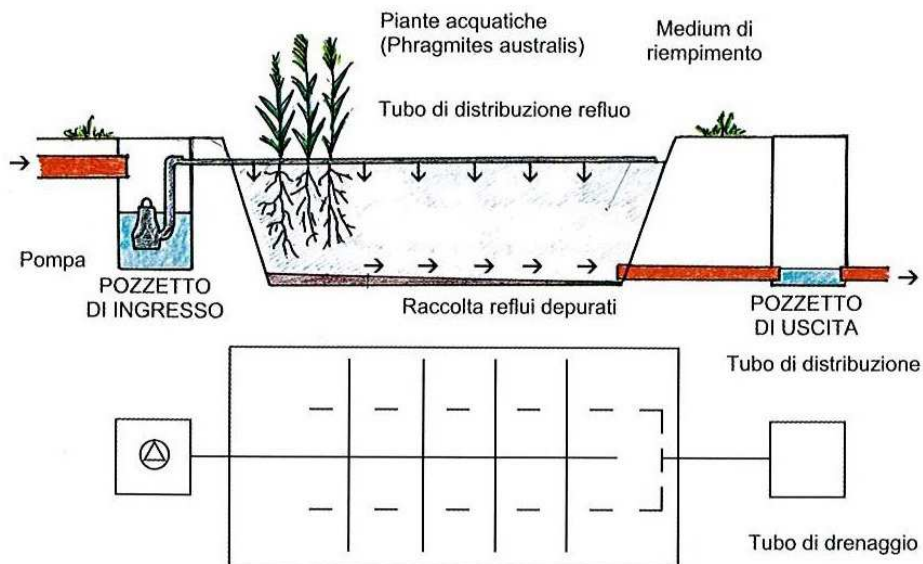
Sistema a flusso sommerso verticale (planimetria e sezione) (Fonte Abram P. – Giardini Pensili. 2011).
